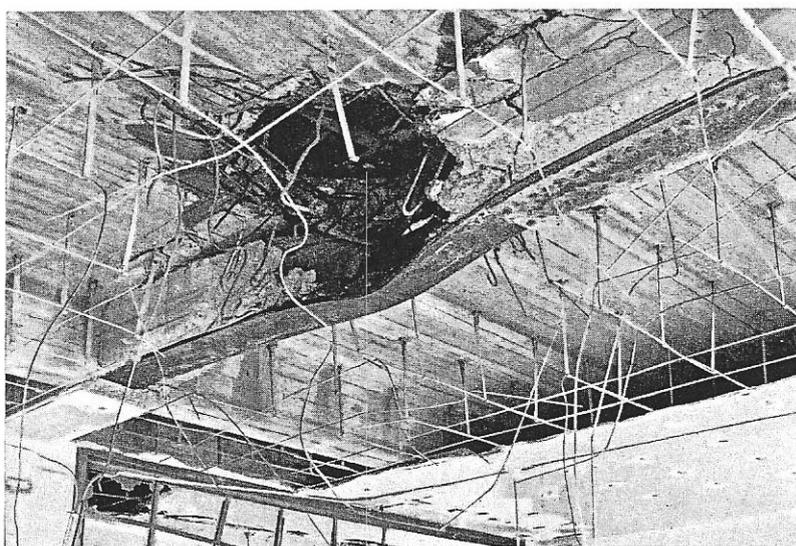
Déformation d'une poutre touchée de plein fouet par une bombe qu'elle a fait ricocher.
